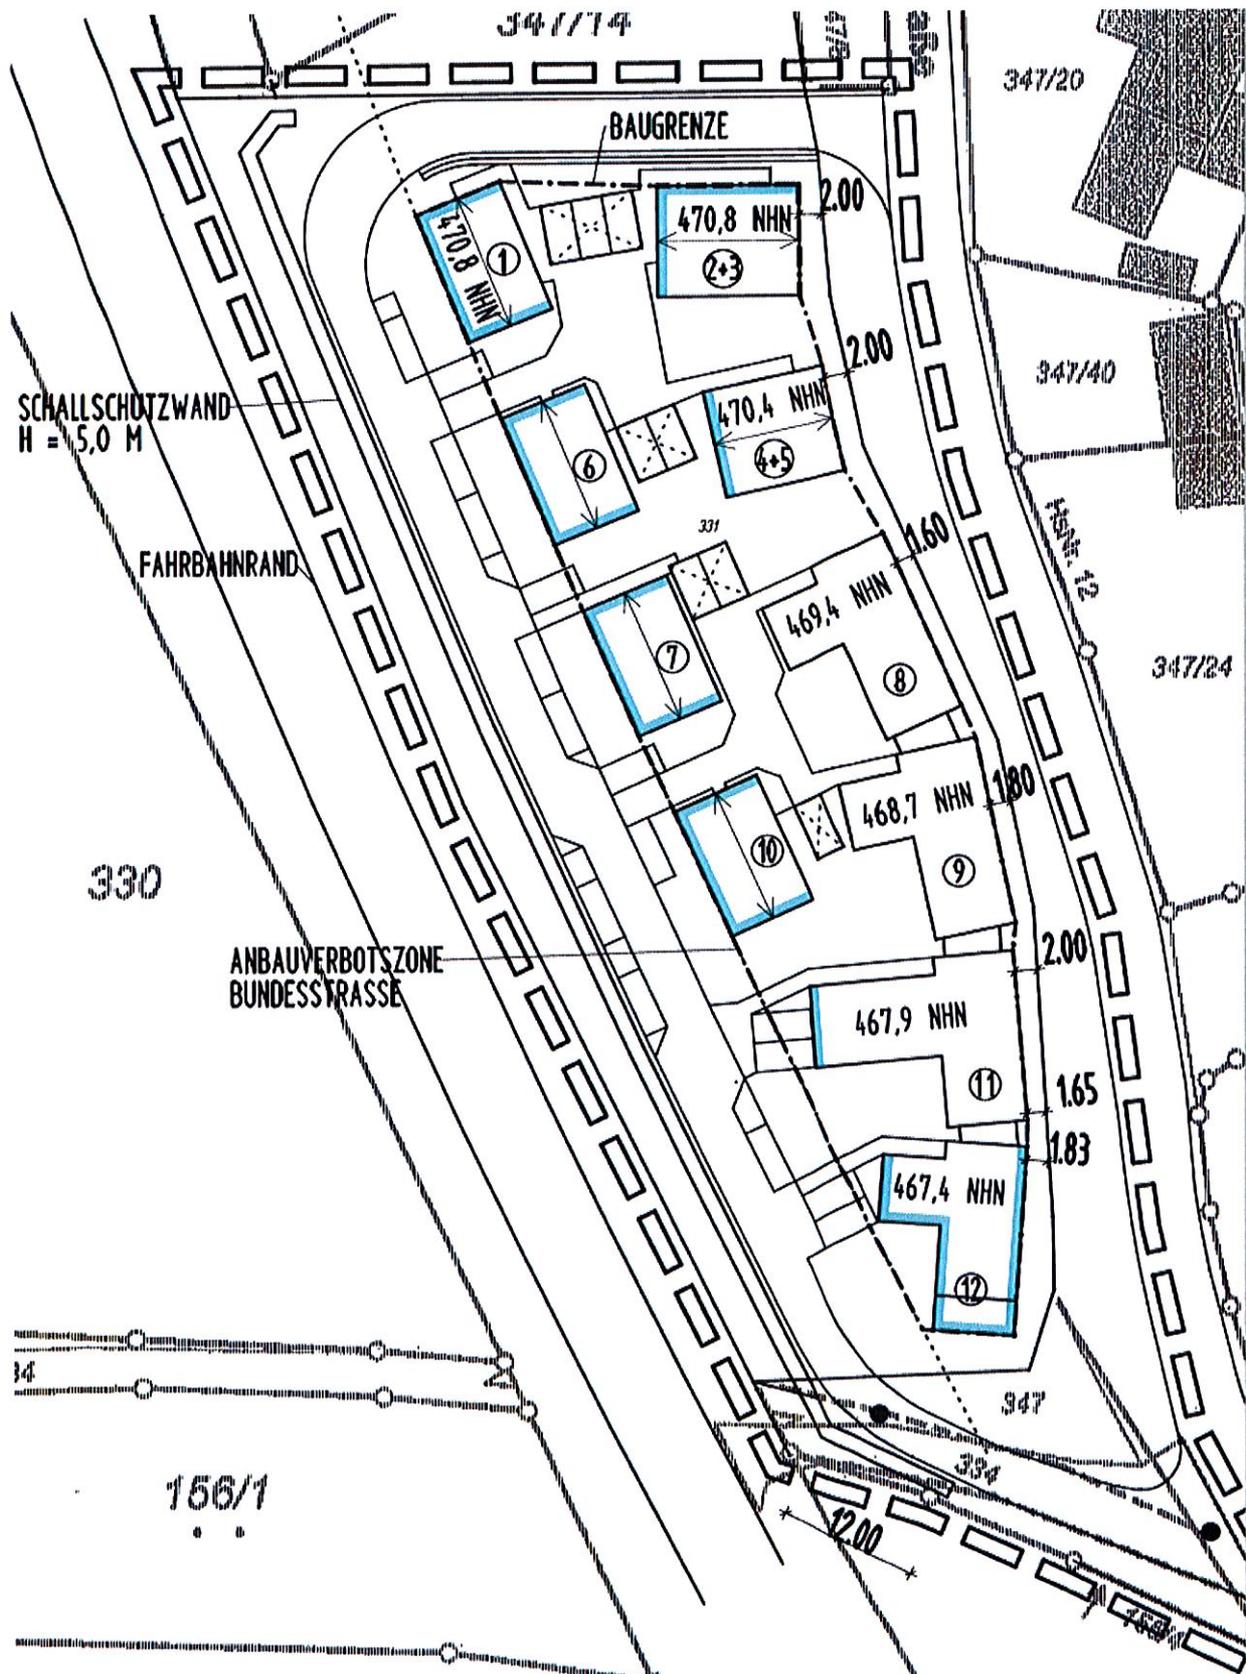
Auszug Lageplan mit Planbebauung, ohne Maßstab, Stand 14. Mai 2019
